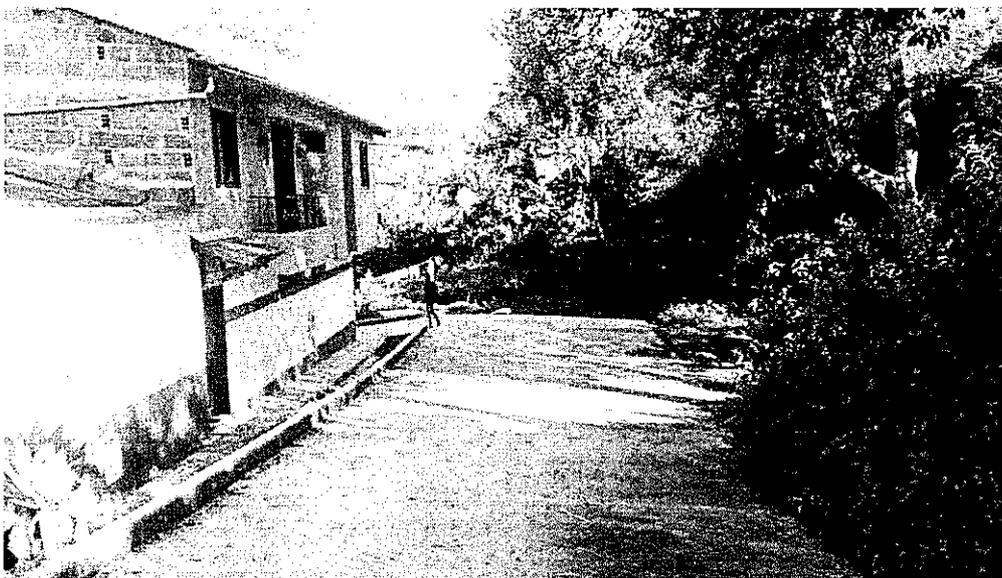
Pavimentación de las vías urbanas, Barrio Los Katios - área conformación y pavimentación
